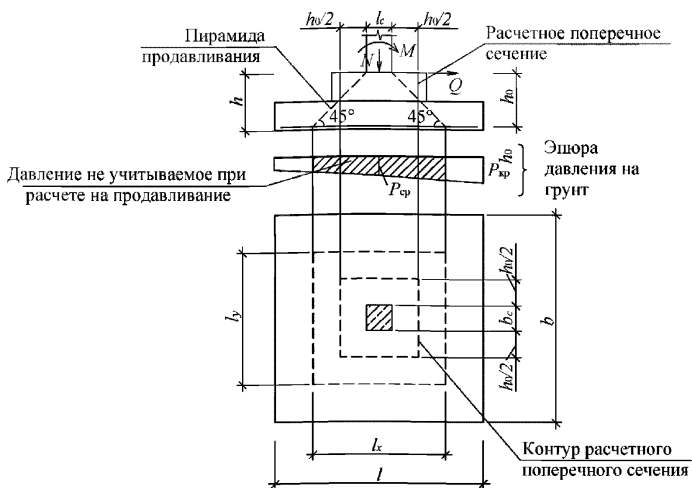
Схема для расчета фундамента на продавливание
